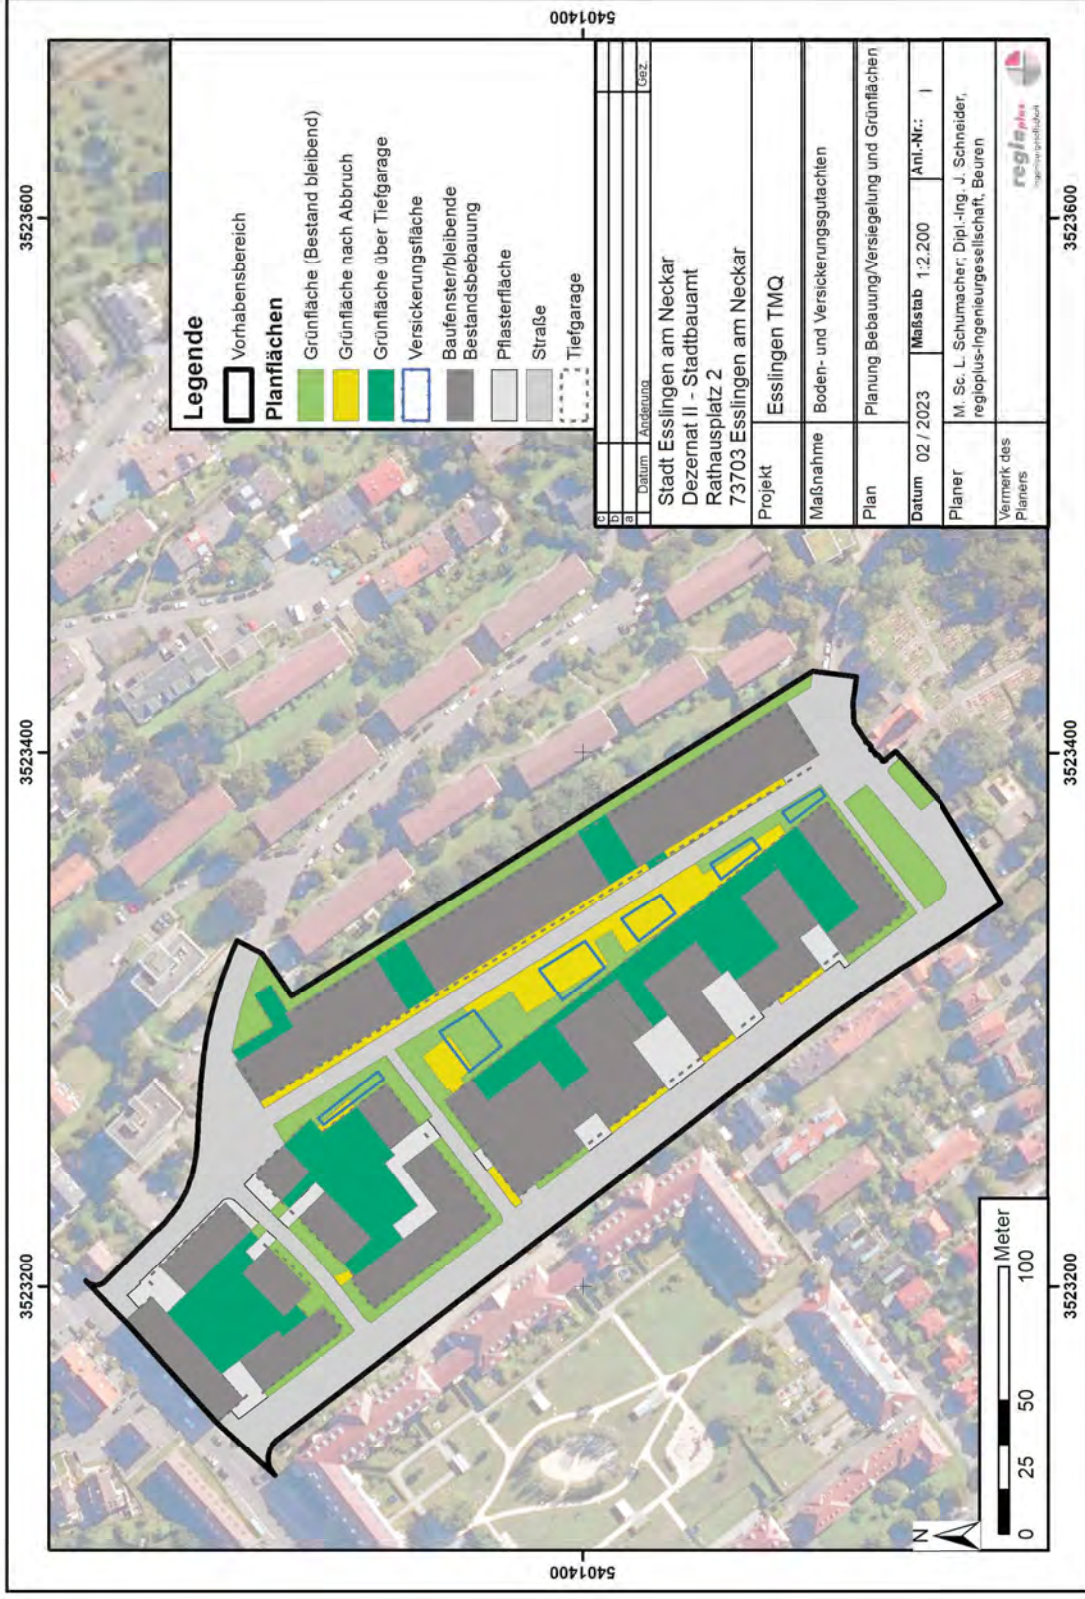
Planung - Bebauung/Versiegelung und Grünflächen
